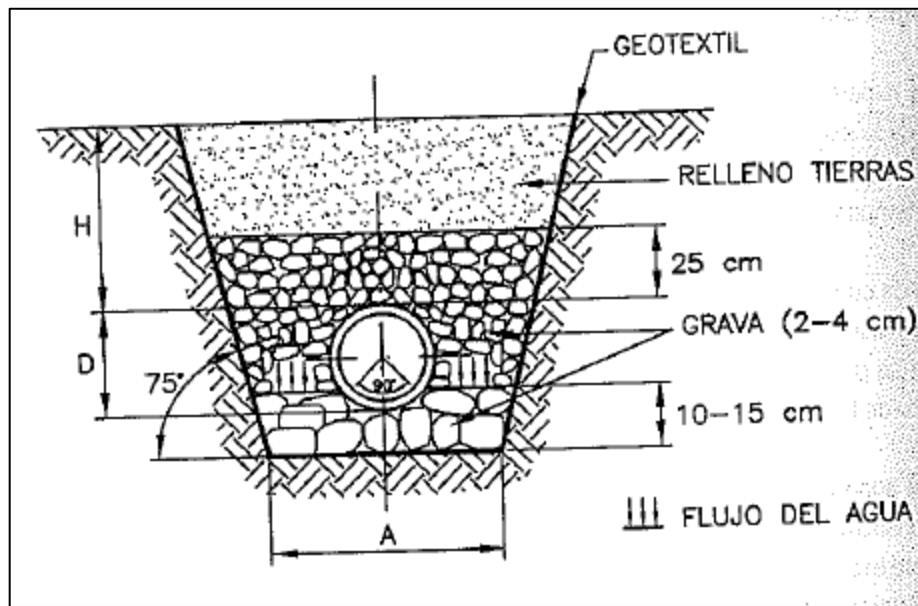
Esquema canaleta de drenaje al pie de la ladera.
